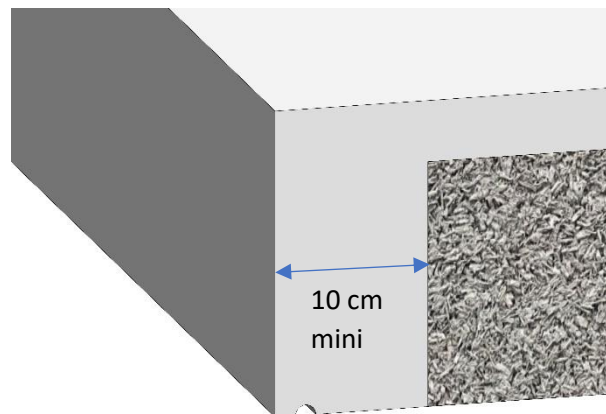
Débord de toiture – gestion de l'étanchéité et goutte d'eau
